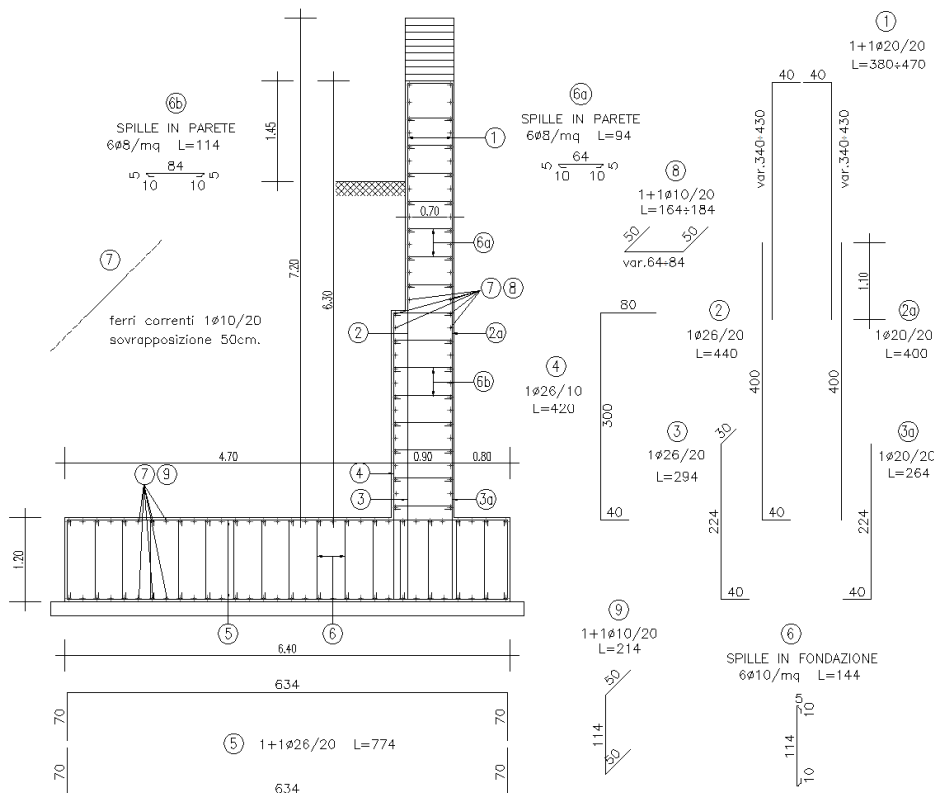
Stato di fatto - Sezione tipo conci 6-7 - Carpenteria e armatura
